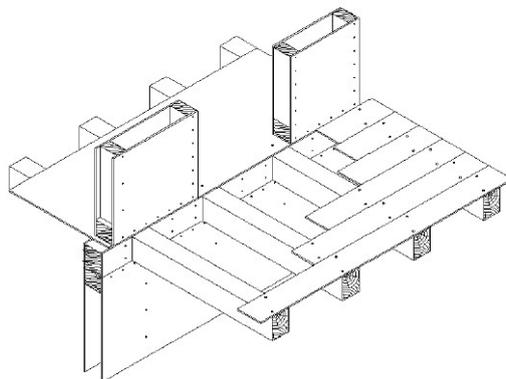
Balcone realizzato in continuità con le travi del solaio
